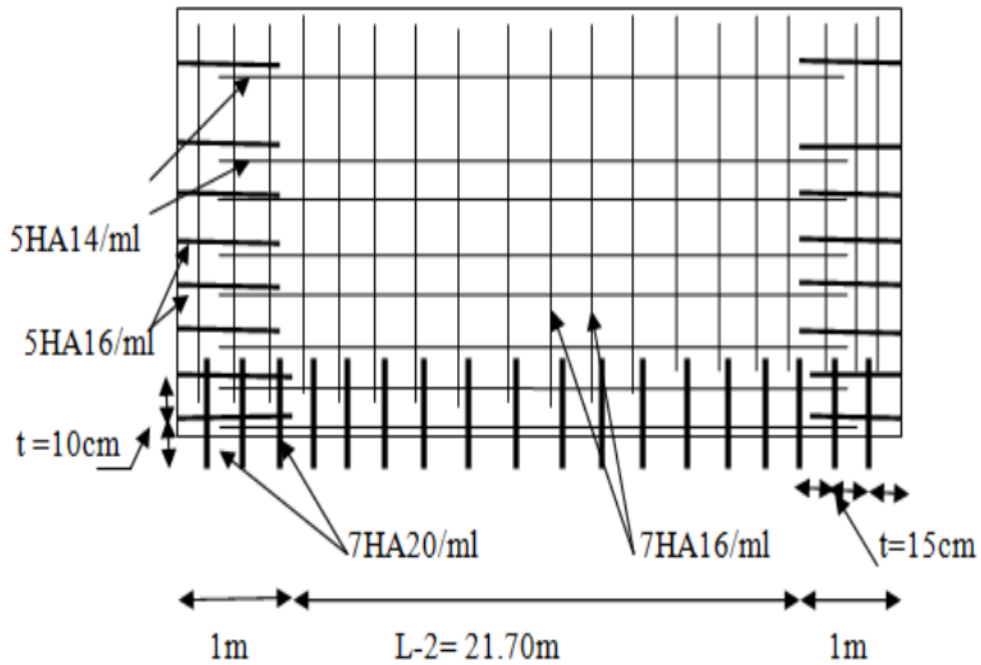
Ferrailage des voiles extérieurs coupe (X-Y).
